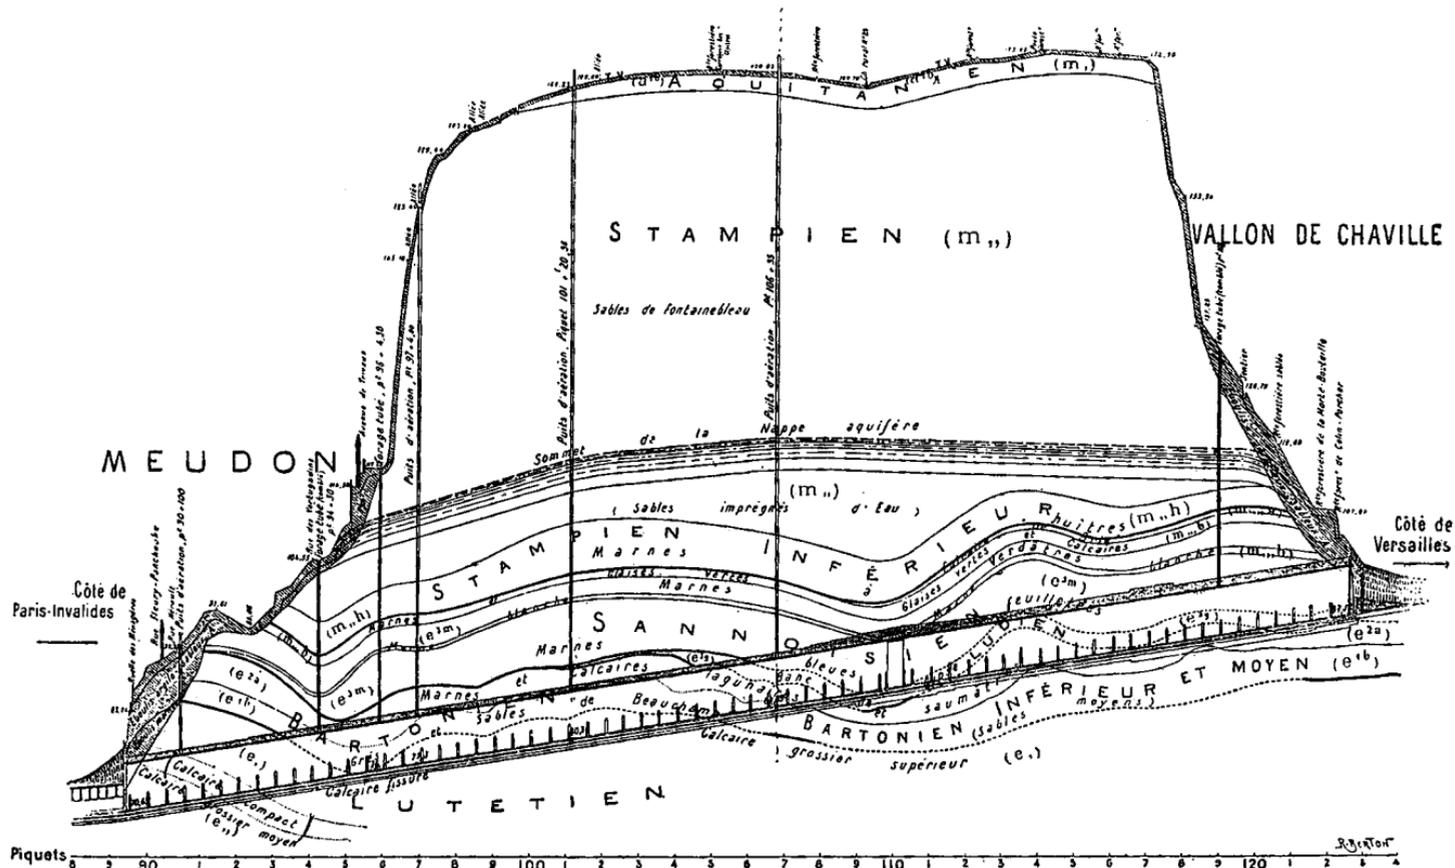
Coupe longitudinale du TUNNEL DE MEUDON par MM. Ramond et Dollot (hauteurs vingtuplées).
